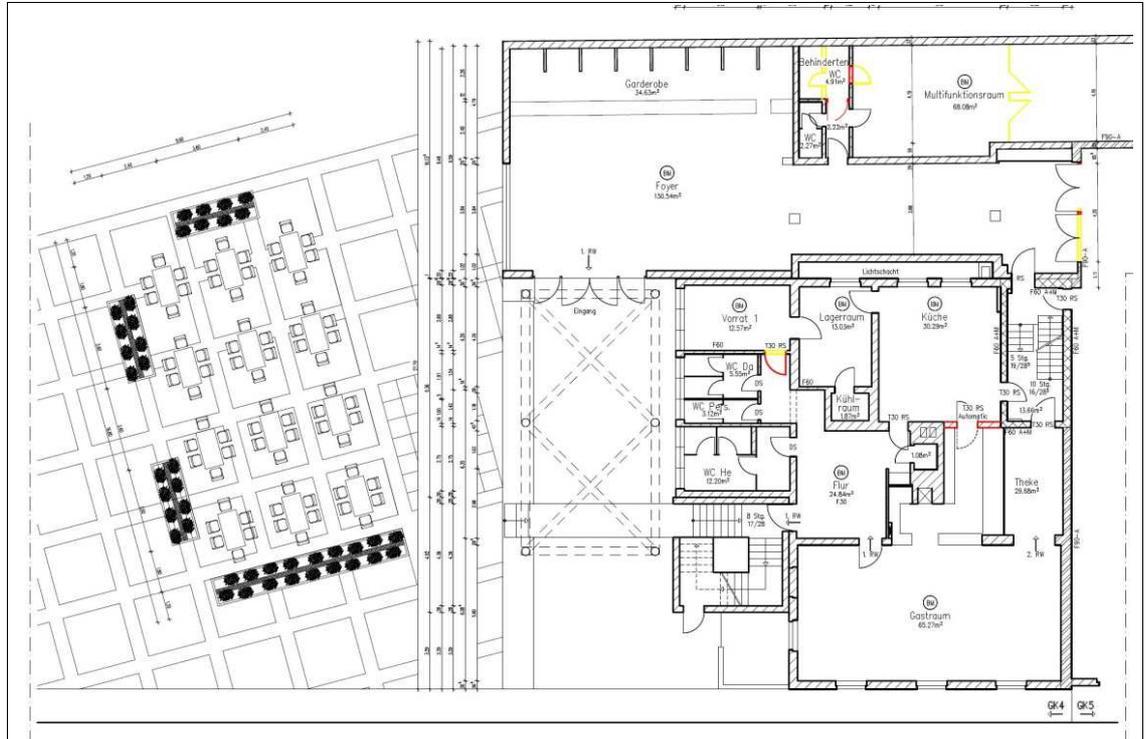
Grundriss Ausführungsvariante B (um 90° gedreht).
